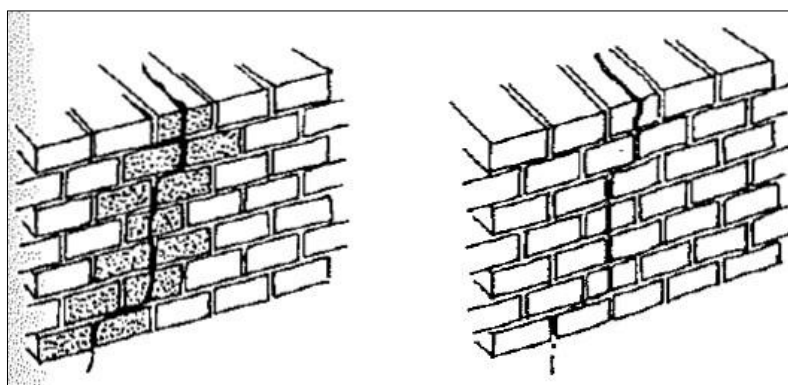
Grieta. – Fuente: Monjo J.⁴³
